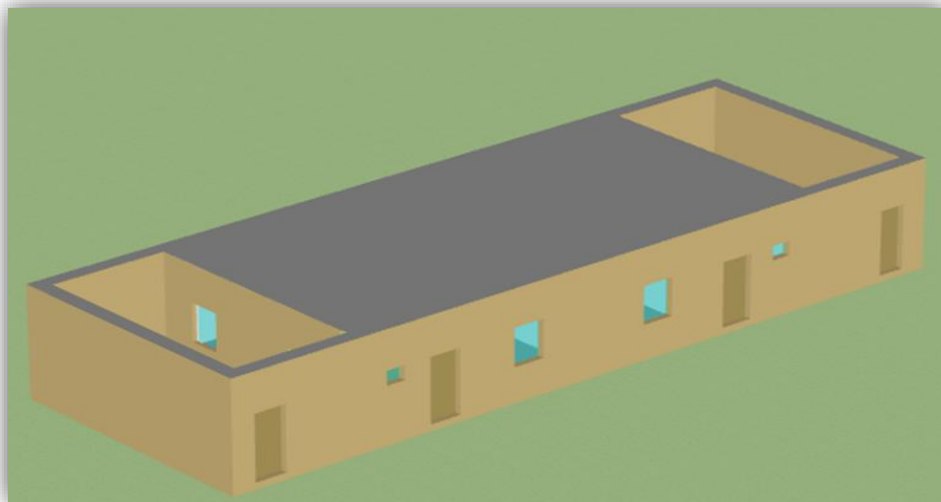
Le plan du logement en 3D dans pléiades Modeleur
